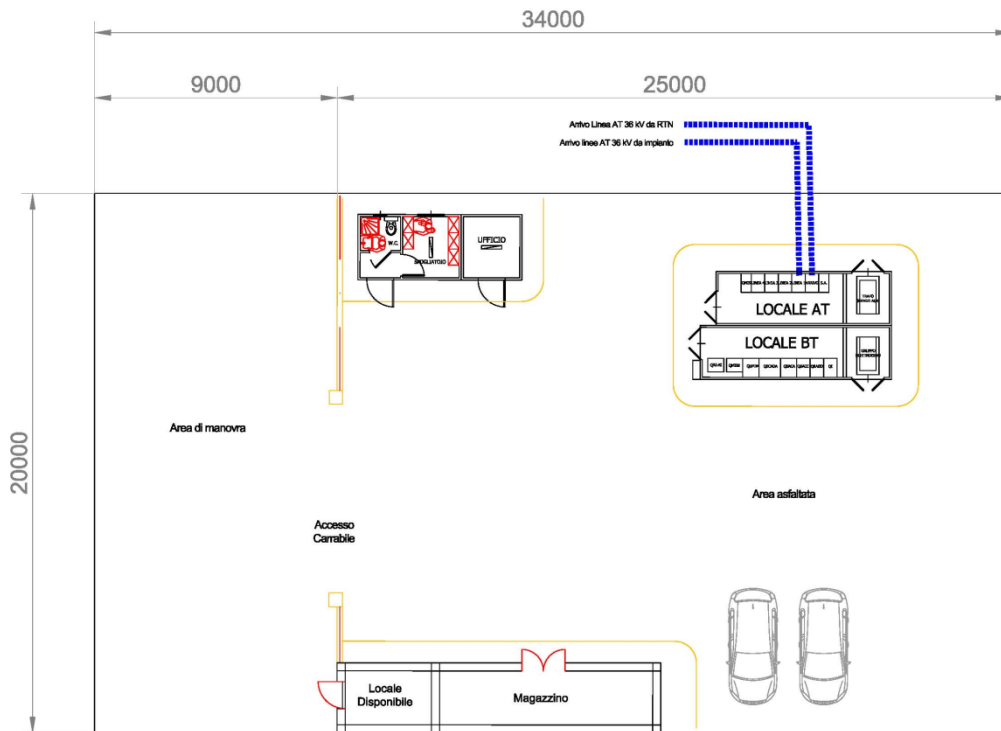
Cabina di Consegna utente – schema planimetrico
